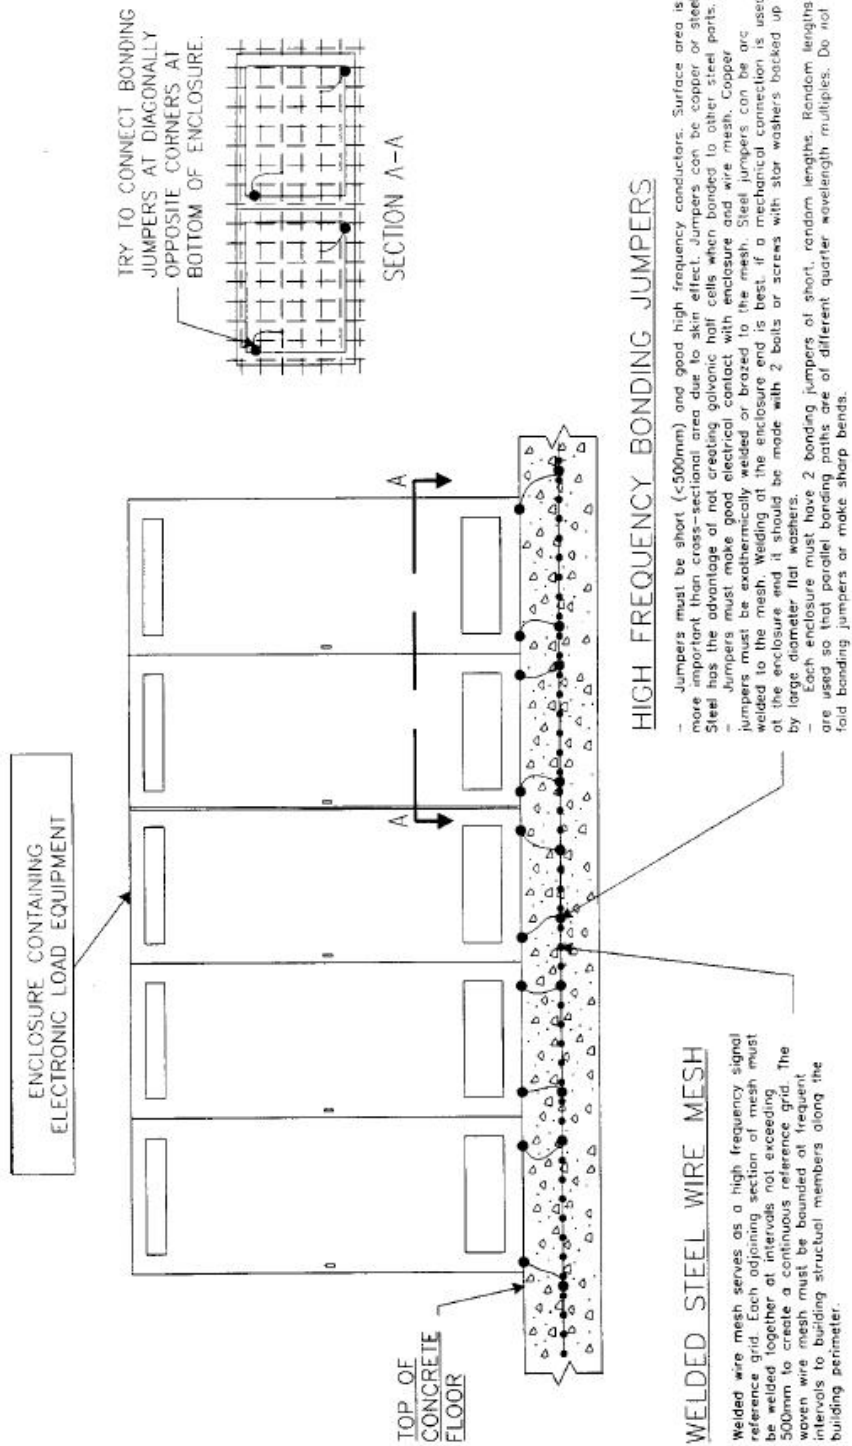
Malla de señal de referencia utilizando malla de alambre soldada [35]
